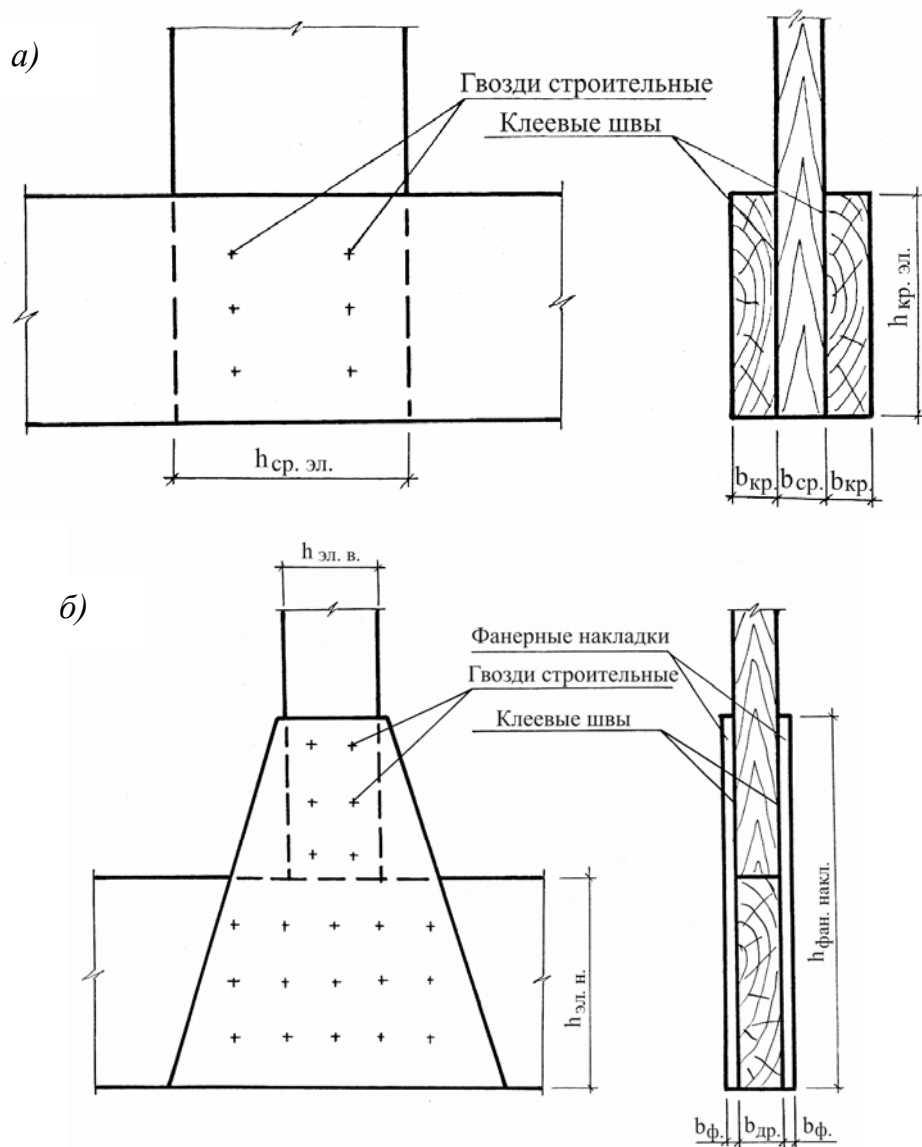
Виды клеевых соединений в узлах дощатых несущих ферм покрытий: а – бесфасоночных; б – с фанерными накладками
